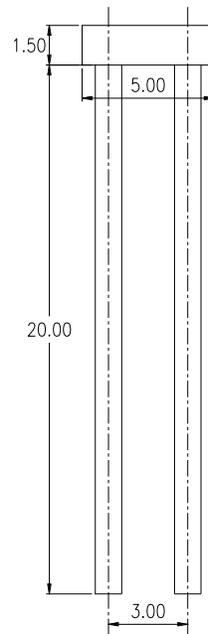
Vista en alzado de la cimentación de cada apoyo intermedio puente Simaña
